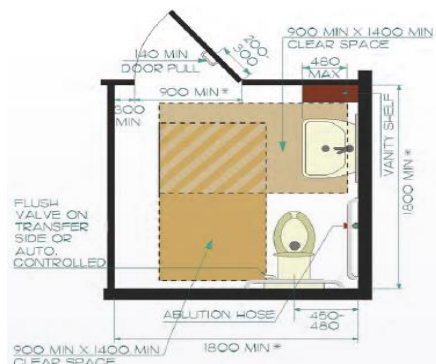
مسقط أفقي لوحدة وضوء
